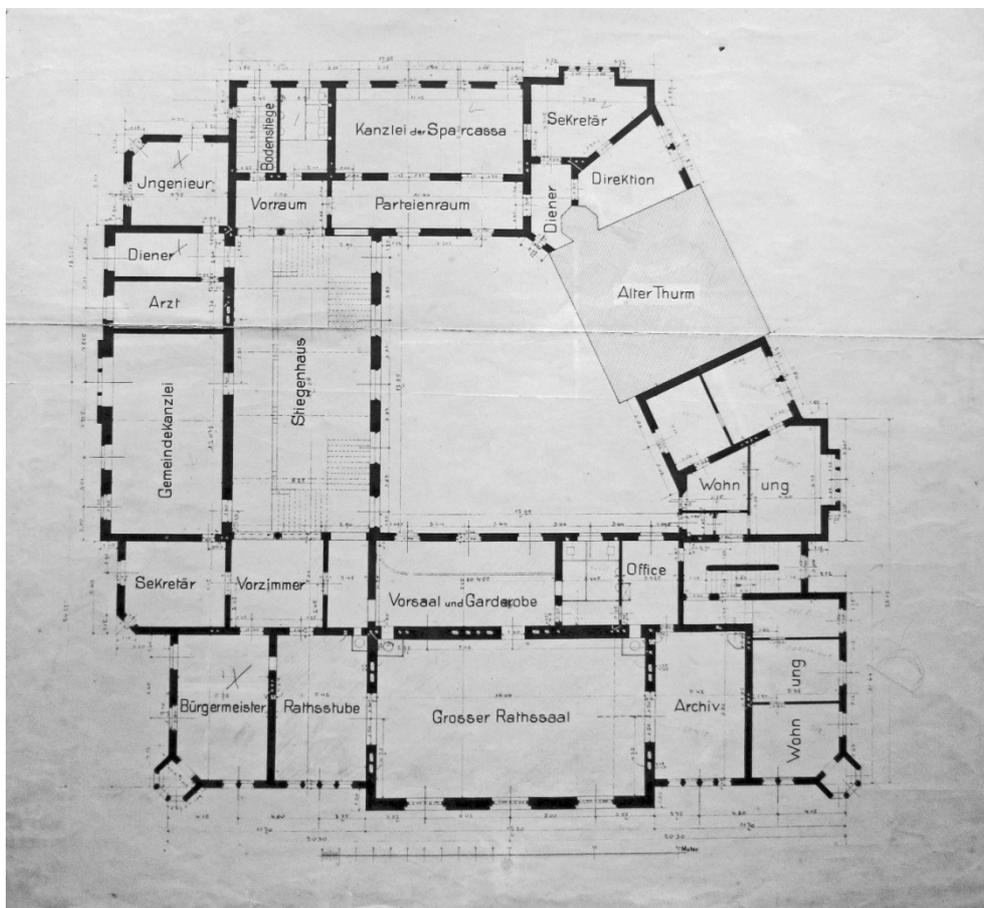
Grundriss des 1.Stockes von Max Kropf
